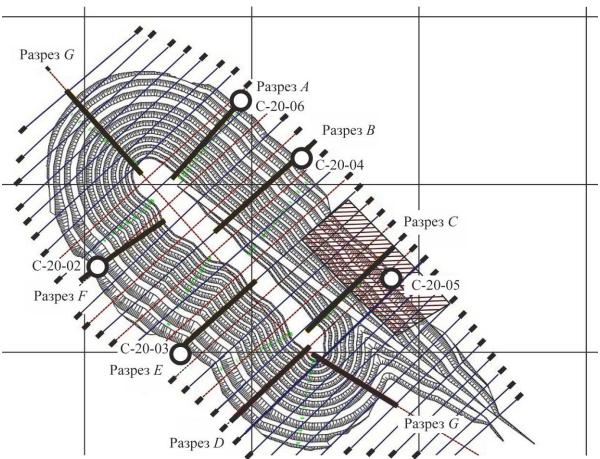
План горных работ на месторождении Коктасжал с расчетными разрезами и ослабленной зоной
